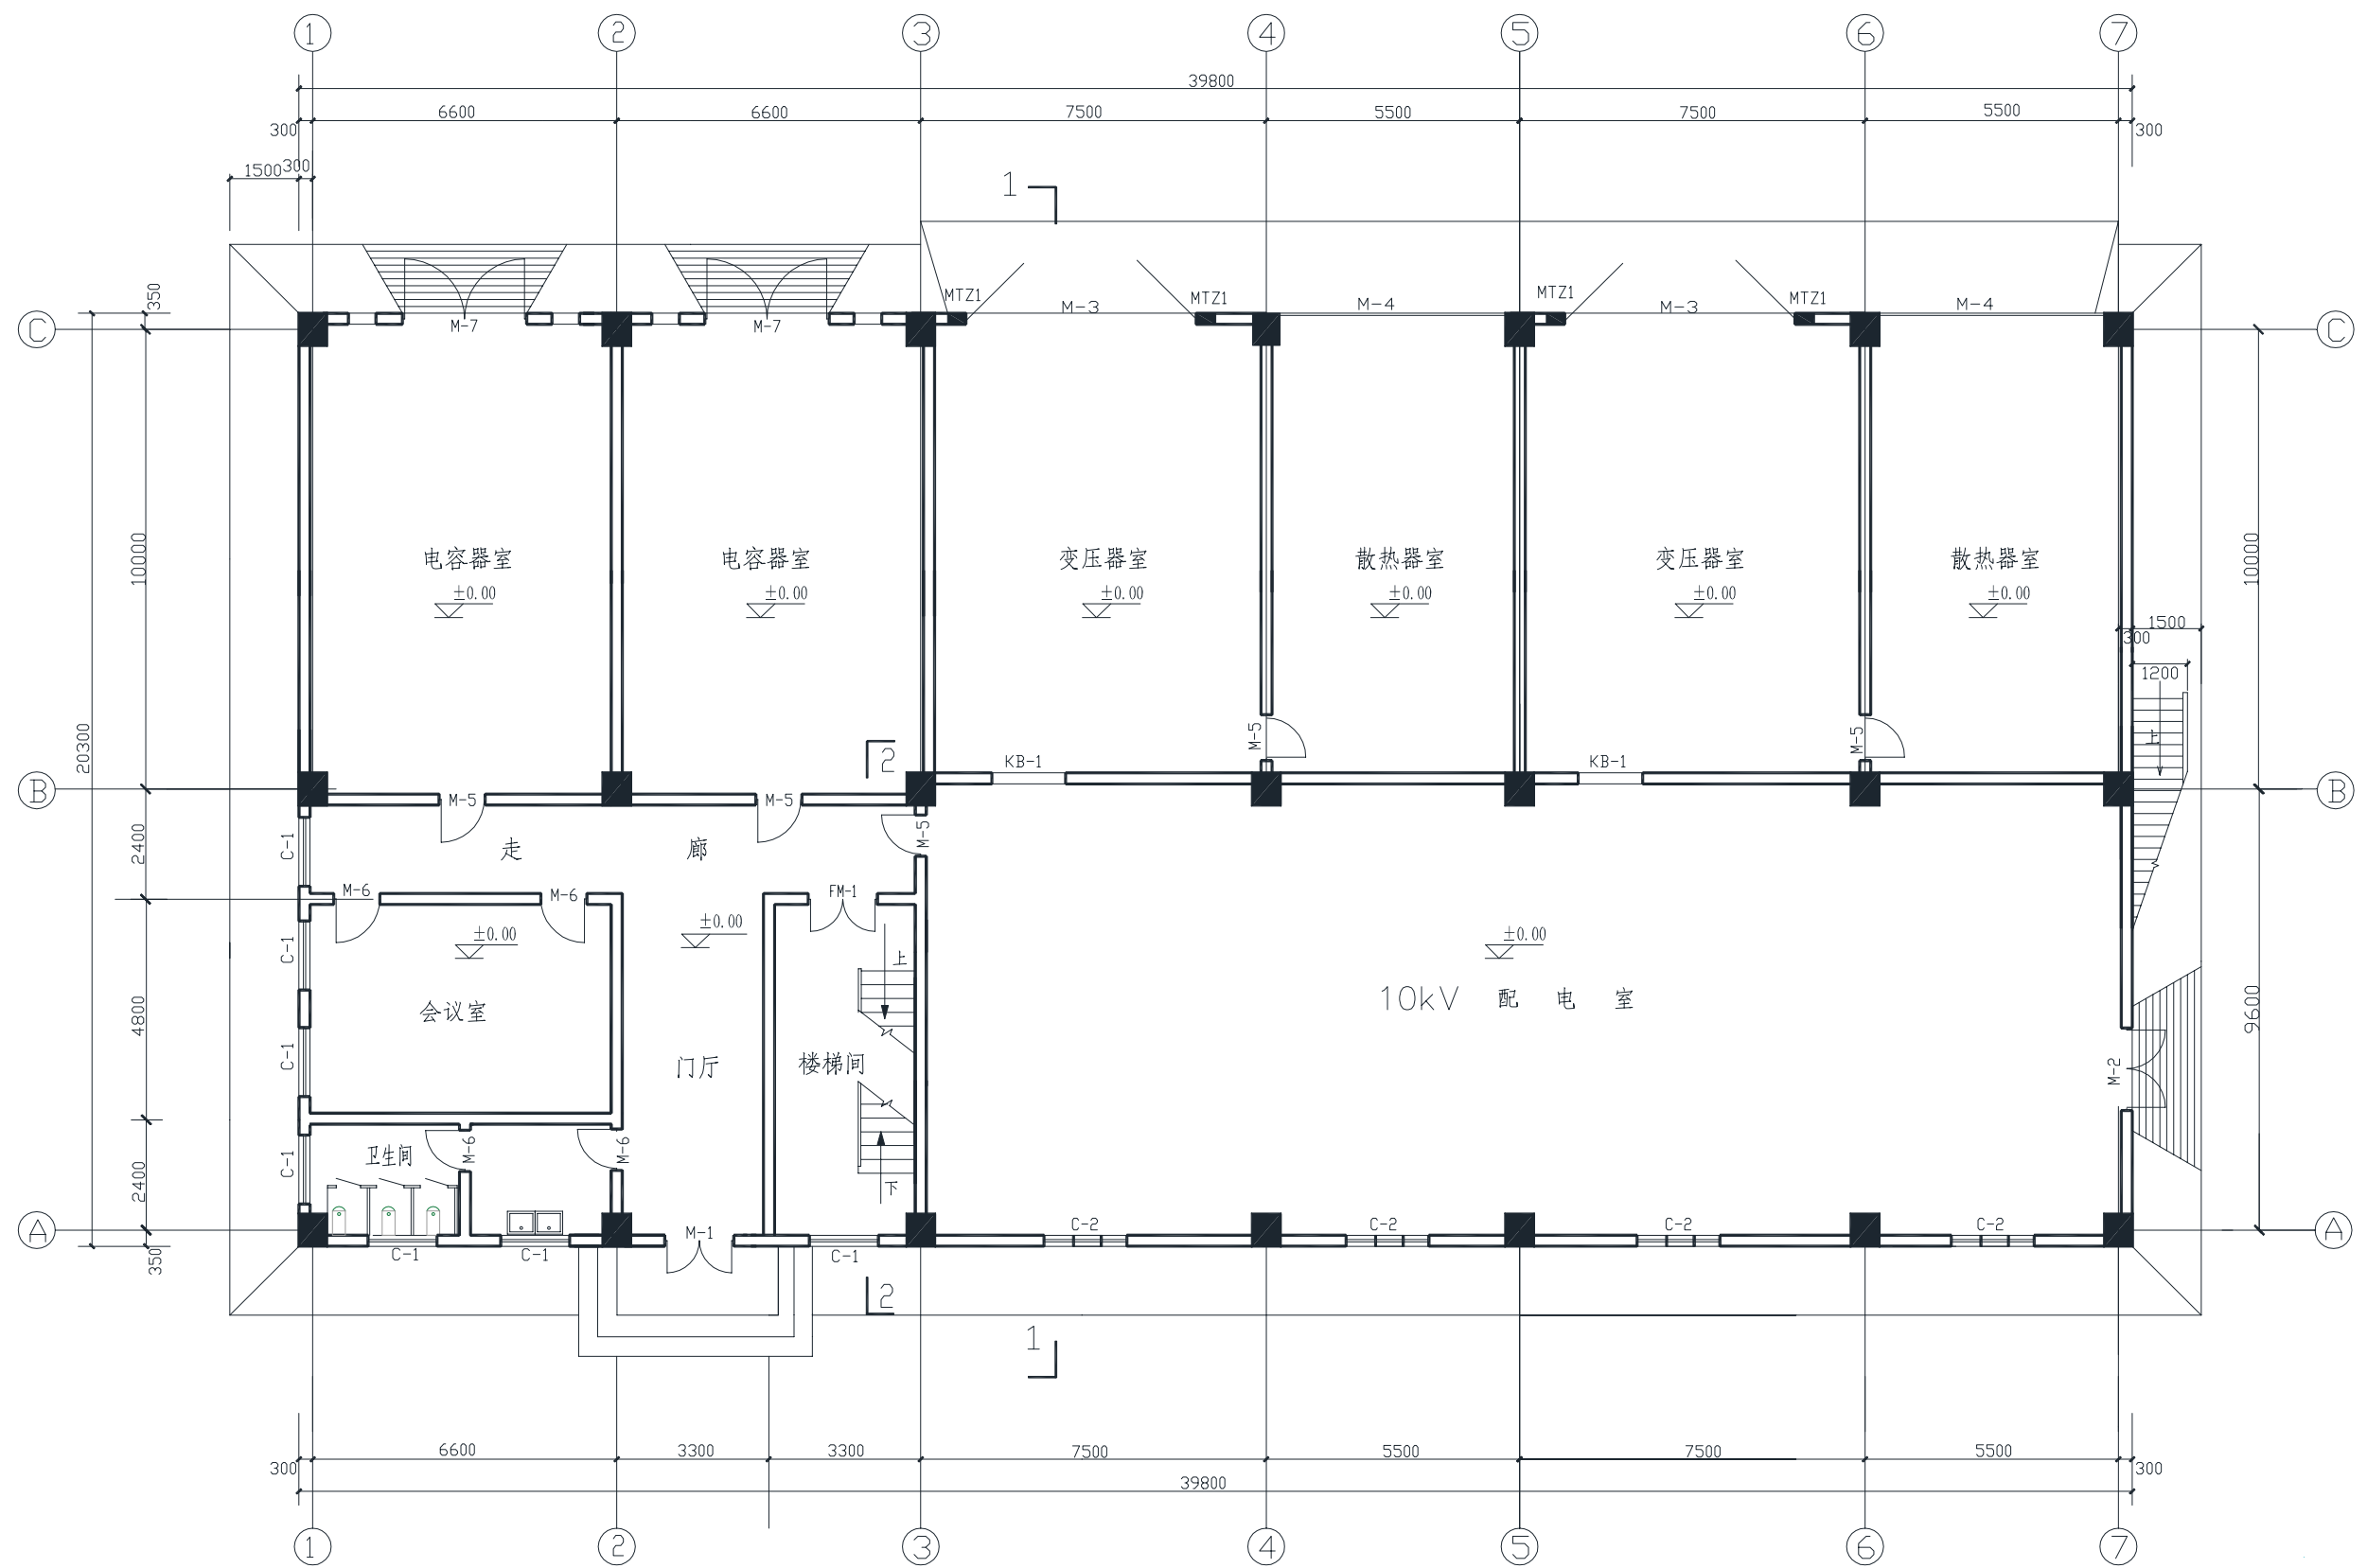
综合配电楼一层平面布置图 (A2-1-06)
